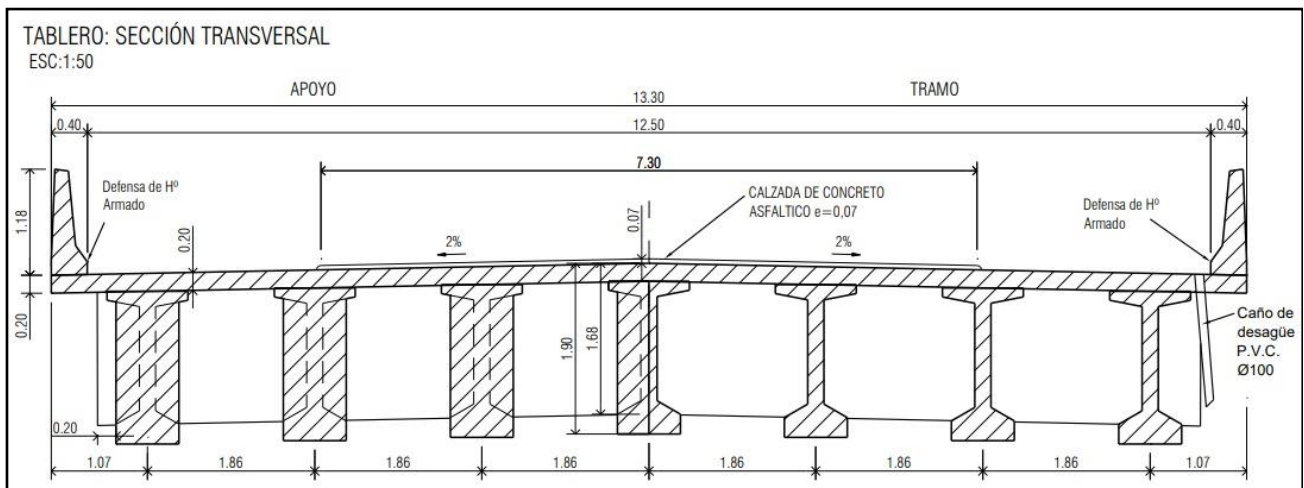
Transversal PUENTE SOBRE R.P. N°2 Y FERROCARRIL
